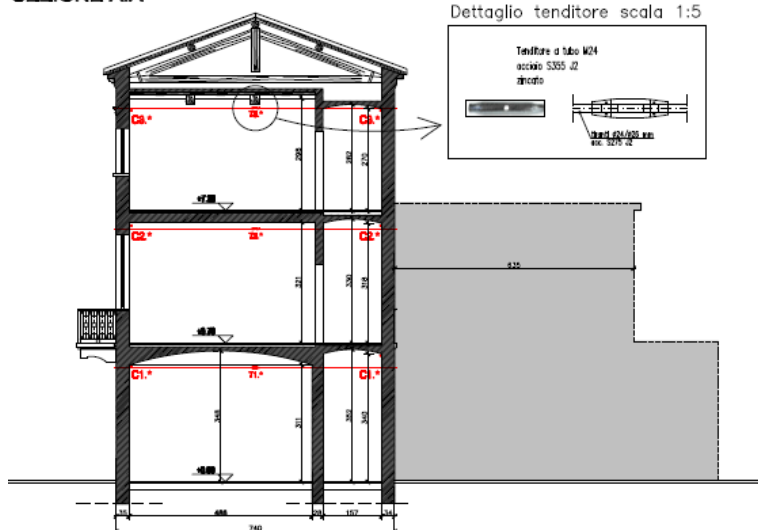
| Sezione A-A – Disposizione in prospettiva dei capochiave
